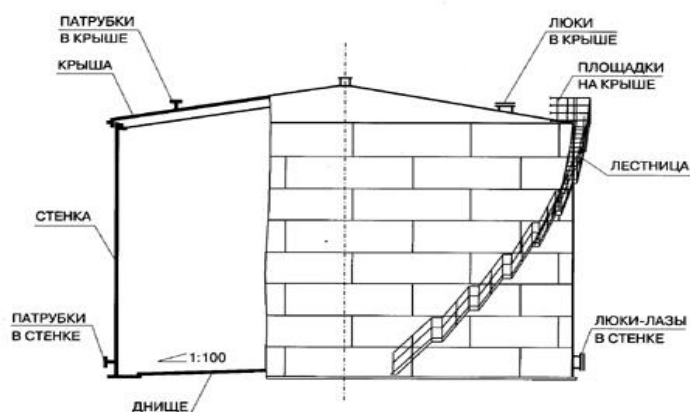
Вертикальный стальной цилиндрический резервуар РВС-5000 со стационарной крышей [13]
